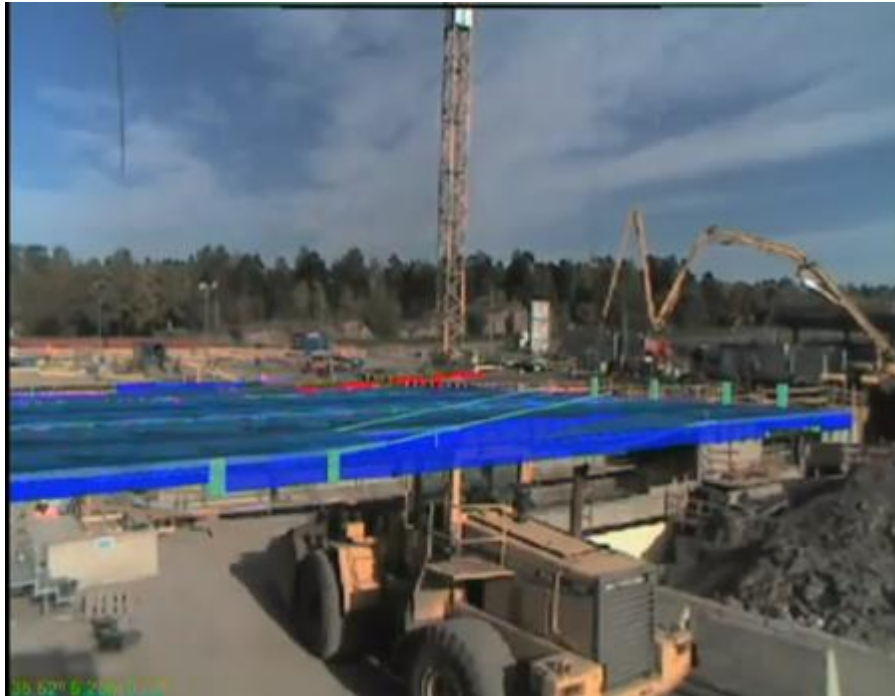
Sobreposição dos elementos a construir utilizando RA (VTT, 2010)
